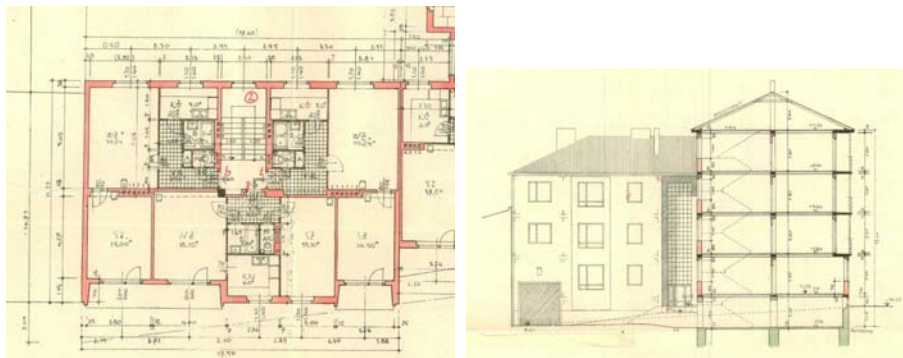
Versuchswohnung Bukalgasse, Grundriss und Schnitt
